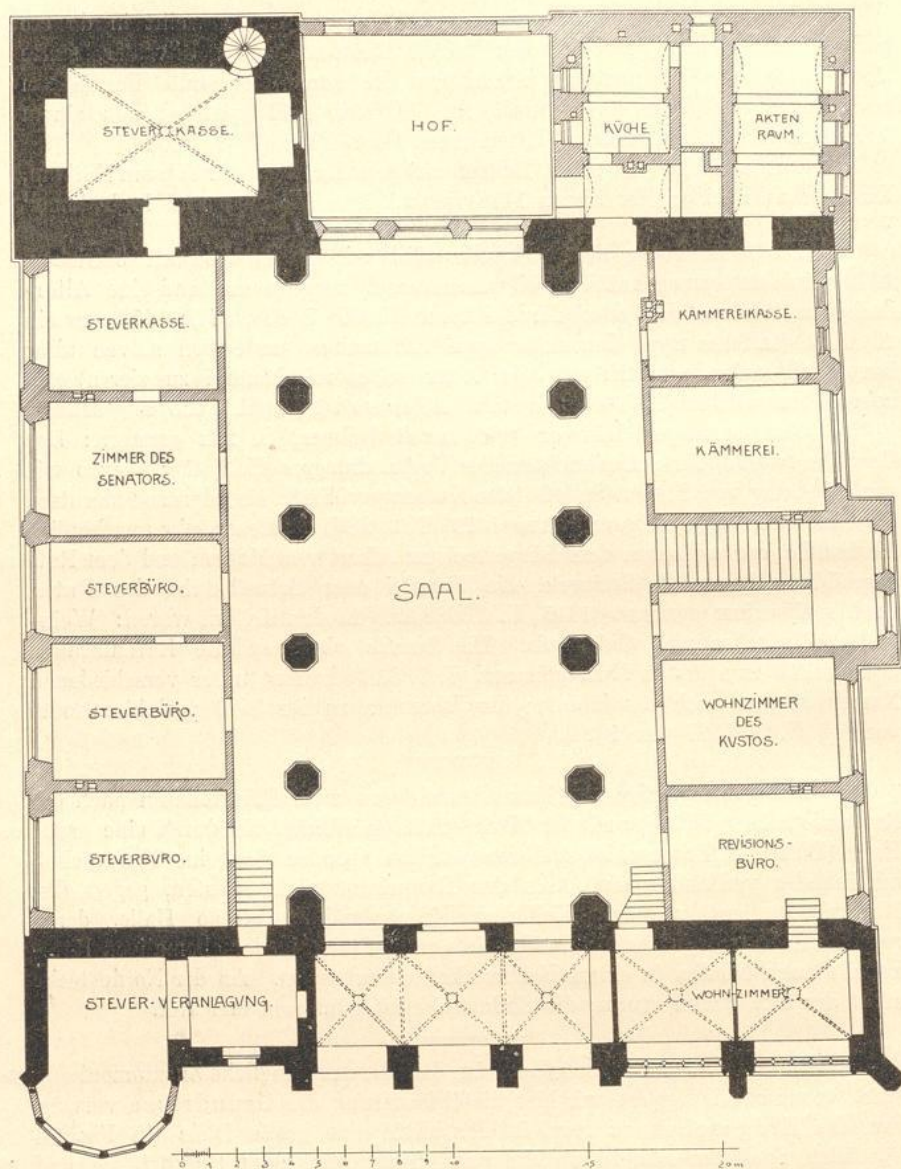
Rathaus. Grundriß Erdgeschoß.
